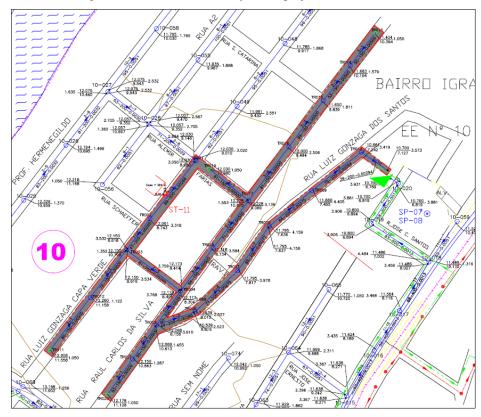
Detalhe do novo traçado do projeto da rede coletora
